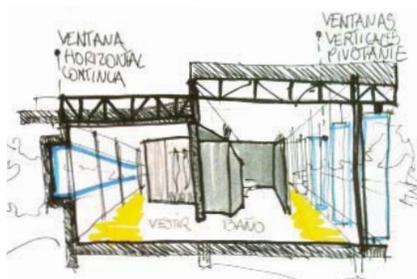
/ CORTE Y PERIMETRO VIDRIADO
